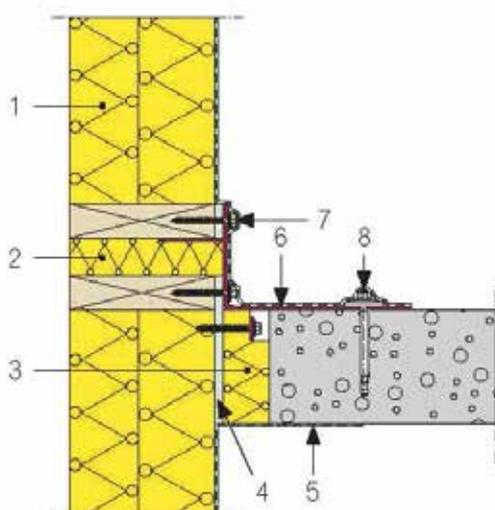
Liaison de l'élément de façade en bois au plancher en béton (configuration testée en laboratoire)
